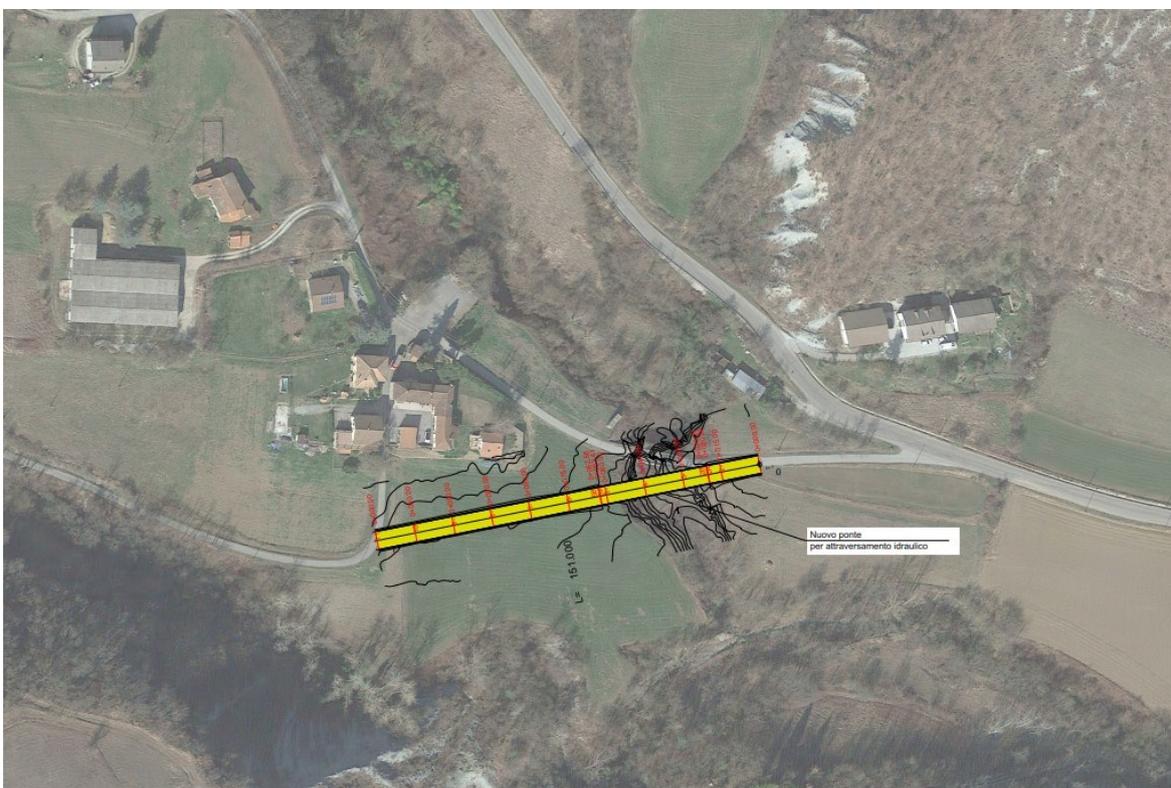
estratto tavola nuova variante stradale prevista a progetto
